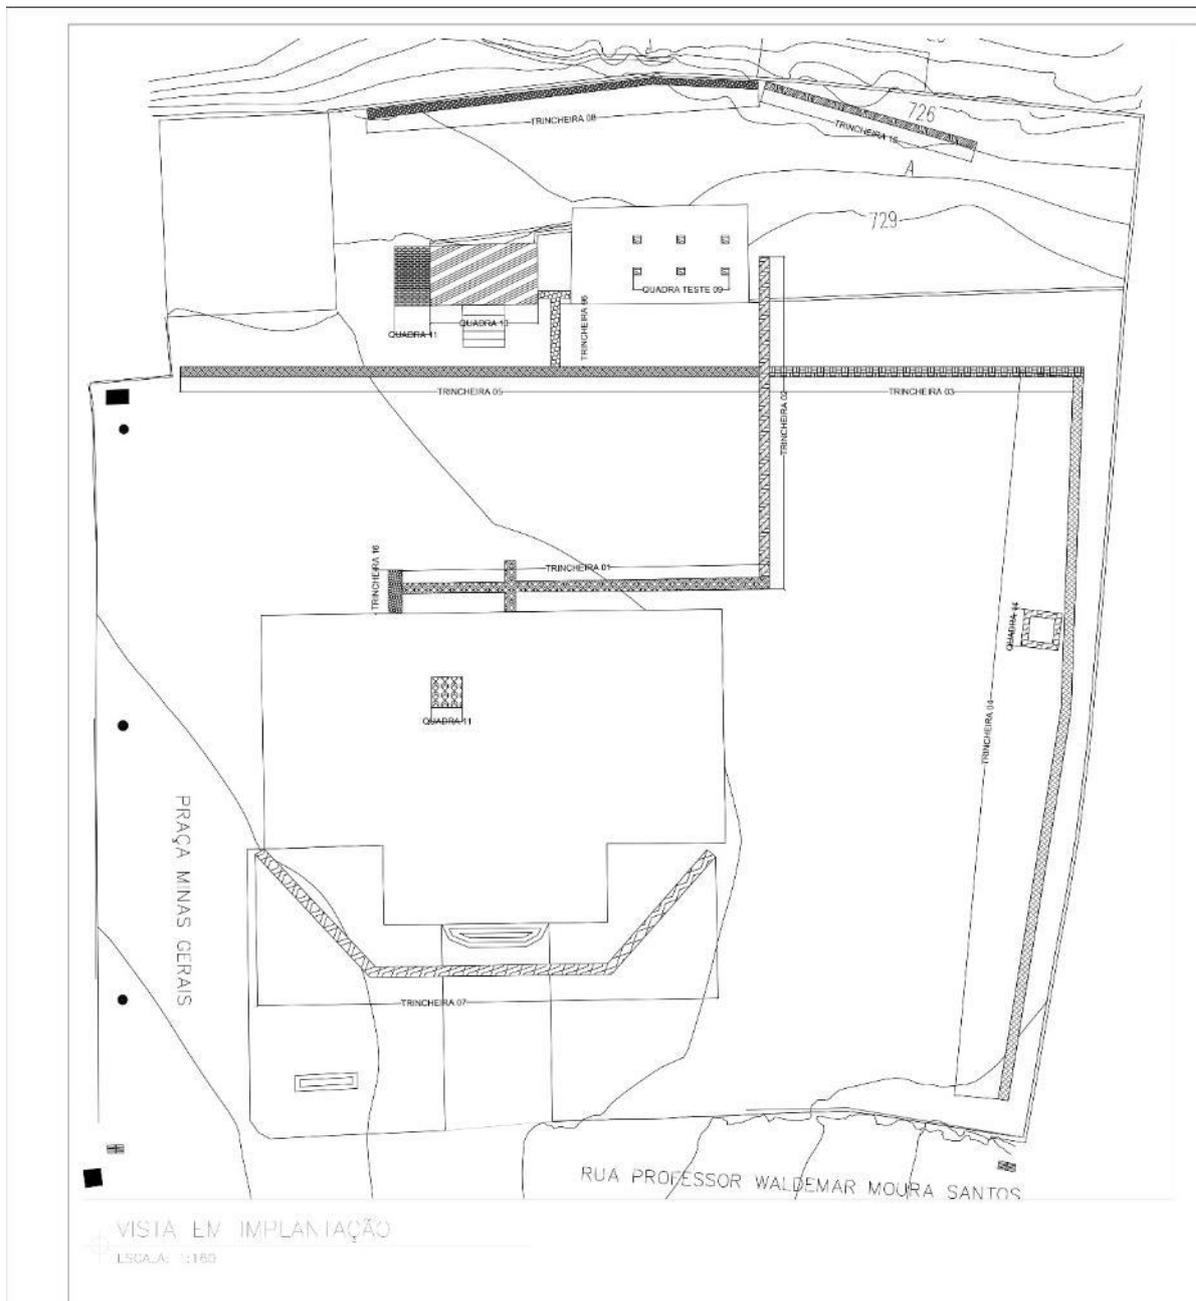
Planta com intervenções na área externa elaborada por A3 Ateliê de Arte Aplicada.
